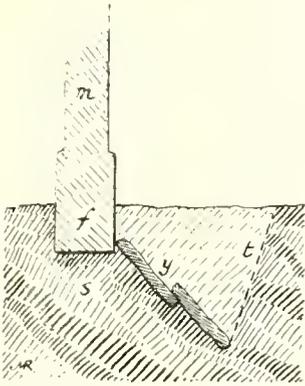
Coupe verticale de pâlis de protection du pied des fondations d'un mur de clôture.
